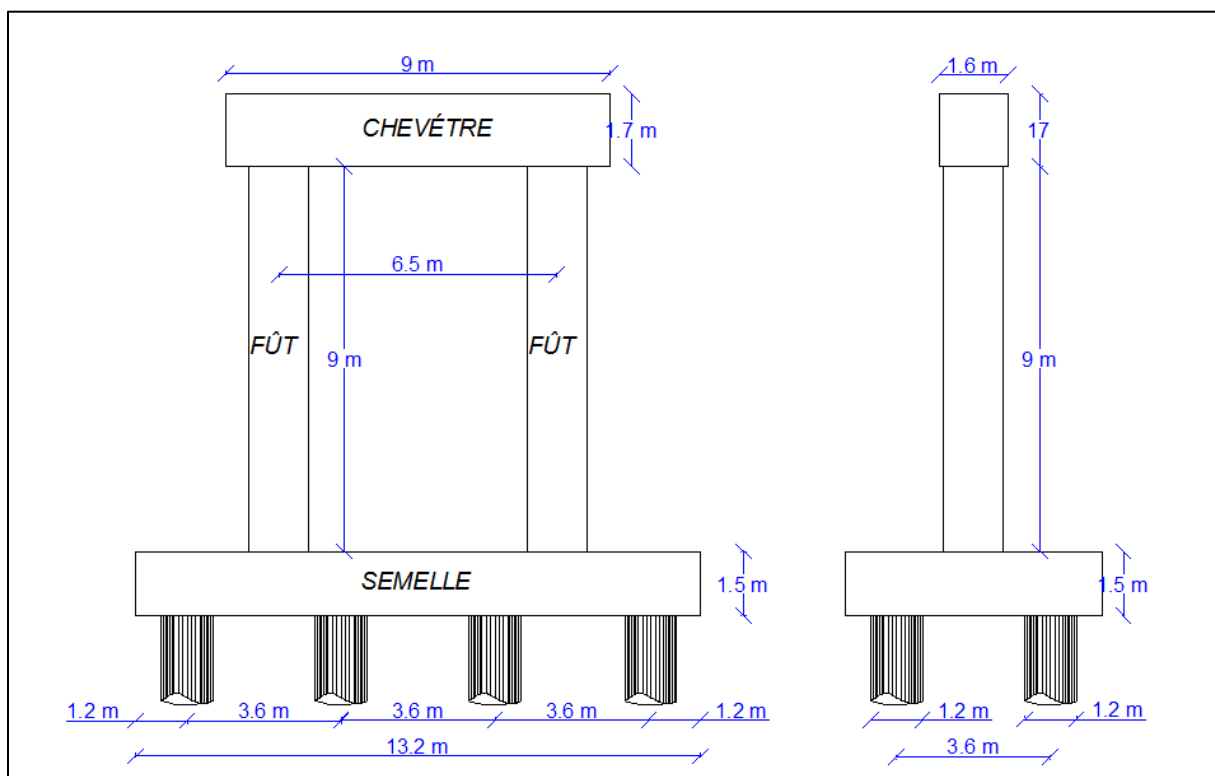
Coupe transversale et longitudinale sur pile.
